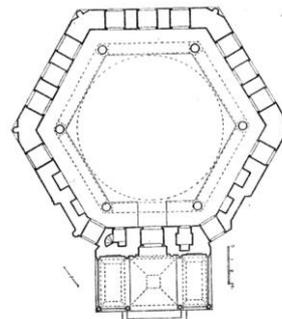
مسقط أفقي لتربة نيجار هانم في أنطاليا عن:
